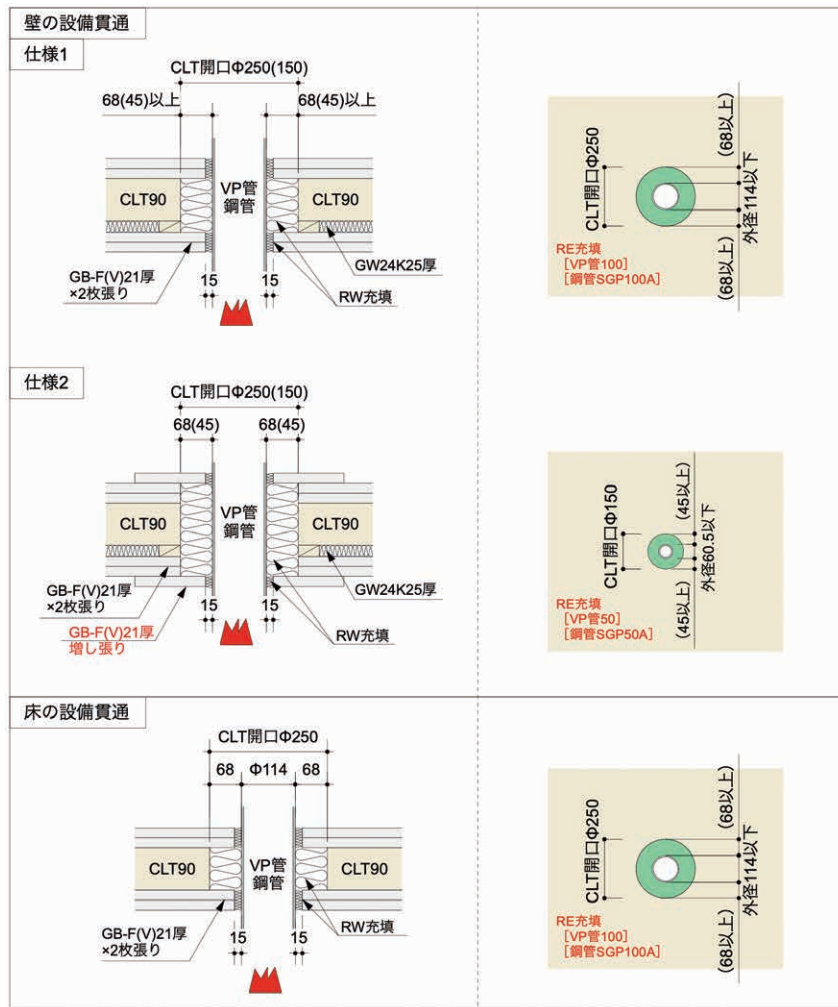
1時間耐火構造壁・床の設備貫通部の納まり案 (単位: mm)
